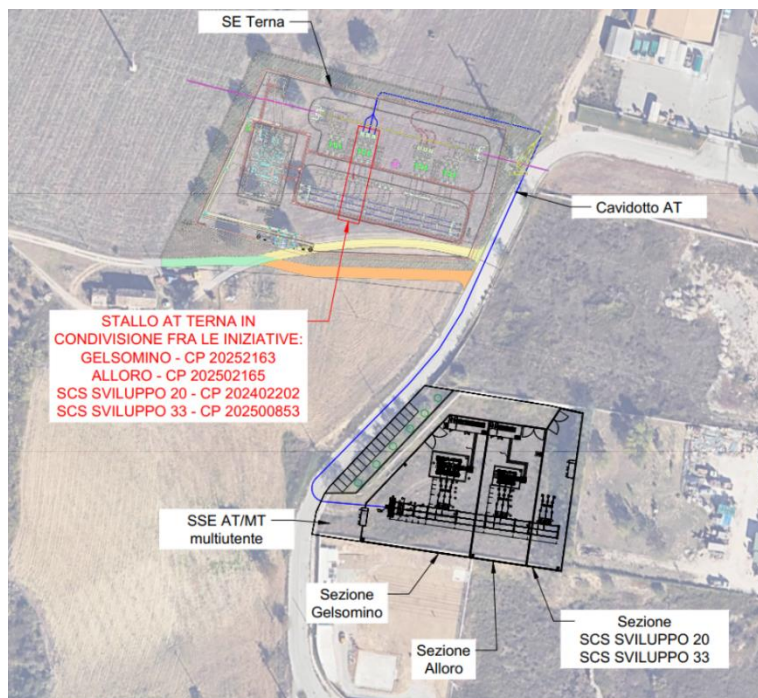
Connessione della SSE multiutente alla Stazione Terna
